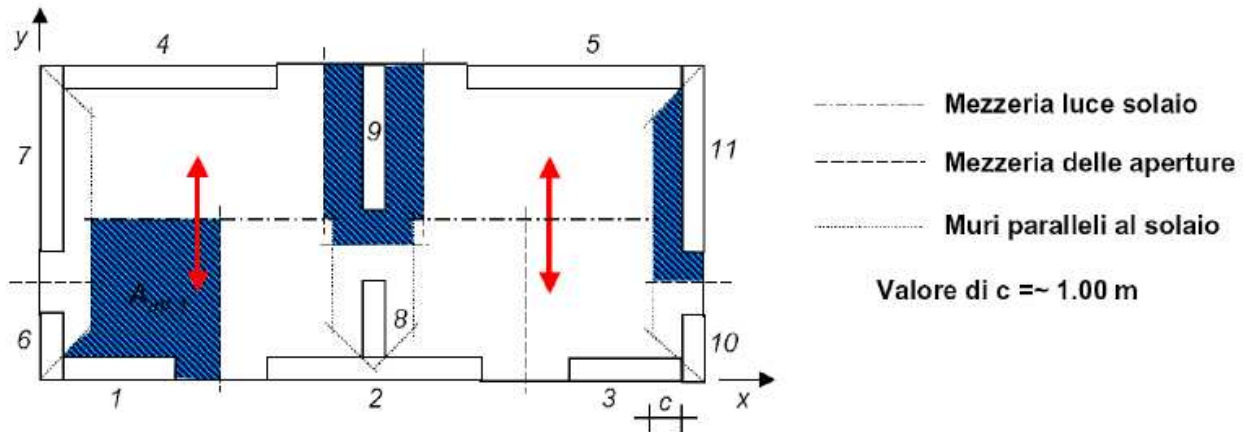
Distribuzione del carico verticale e delle forze orizzontali sui muri
